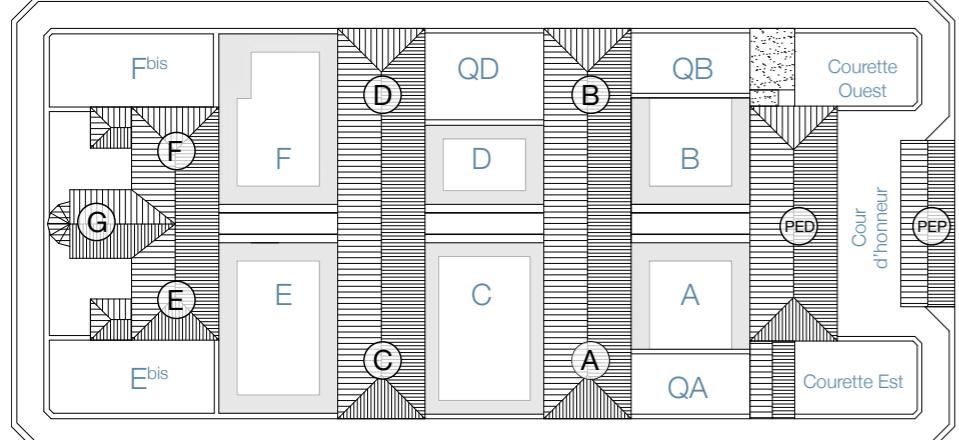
Plan de repérage des dallages en pierre de volvic présents en 1966, d'après photographie aérienne. Source : Croisée d'archi
